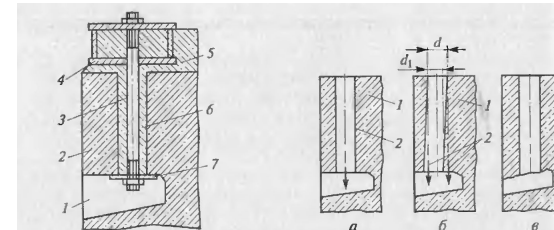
Колодец в фундаменте для установки фундаментных болтов:
